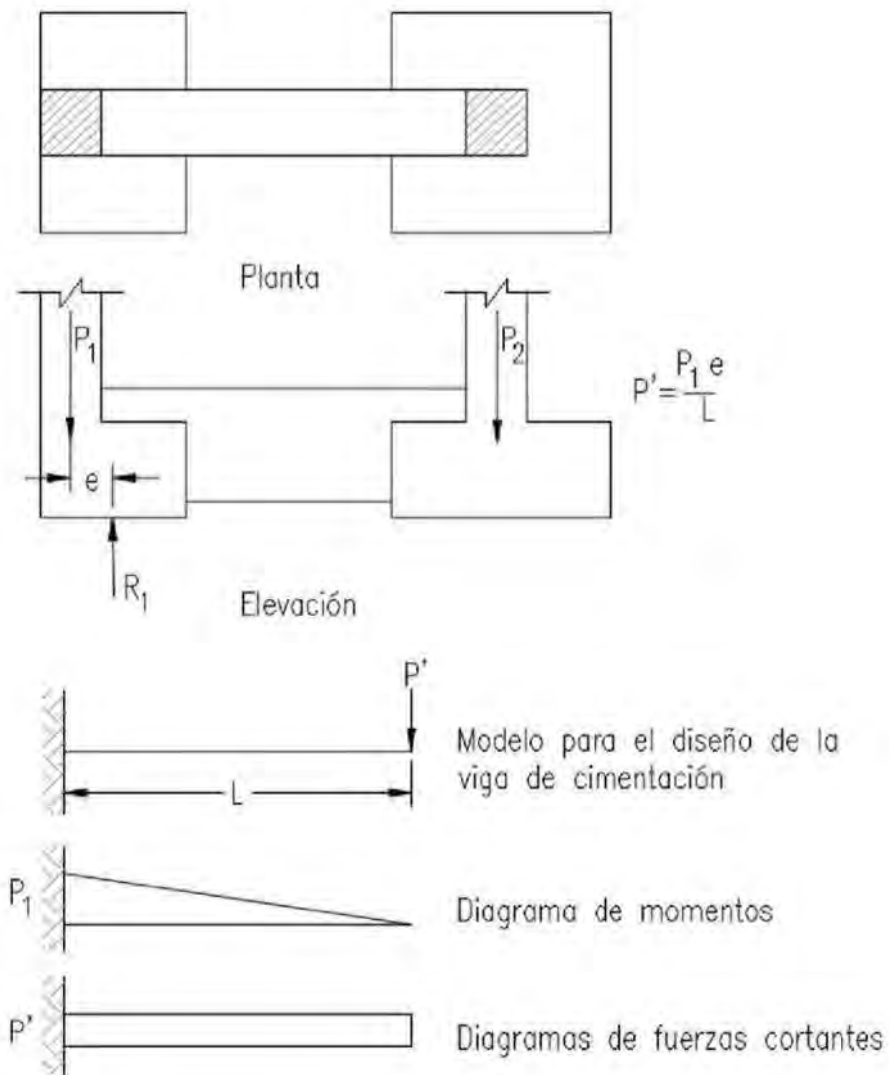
Modelo para el diseño de vigas de cimentación en zapatas conectadas
